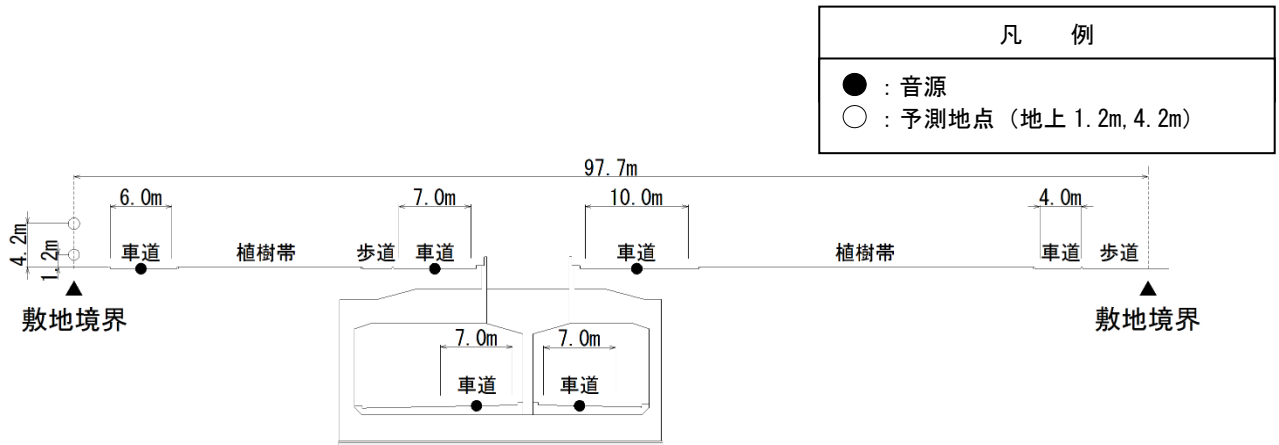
(1) 予測断面图 (A. 一般国道298号)
